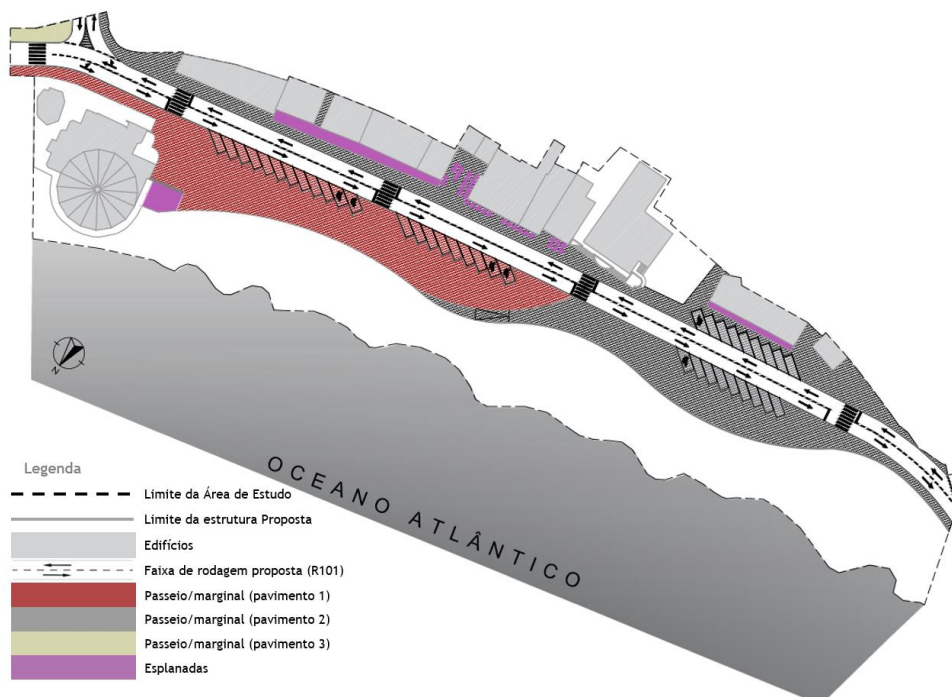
Planta esquemática: Zona do Calhau. Estacionamento. [s/escala]
